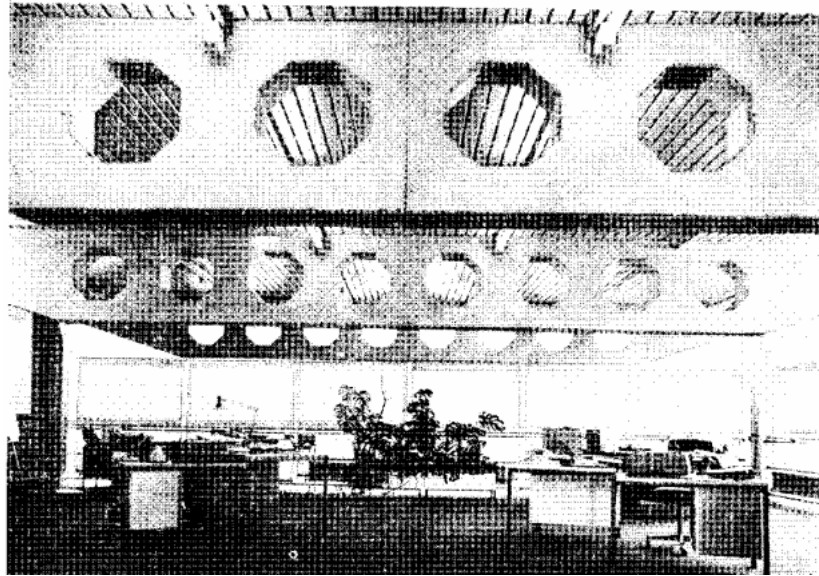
Приклад інтер'єру з оголеними фермами. Адміністративна будівля в Відені
